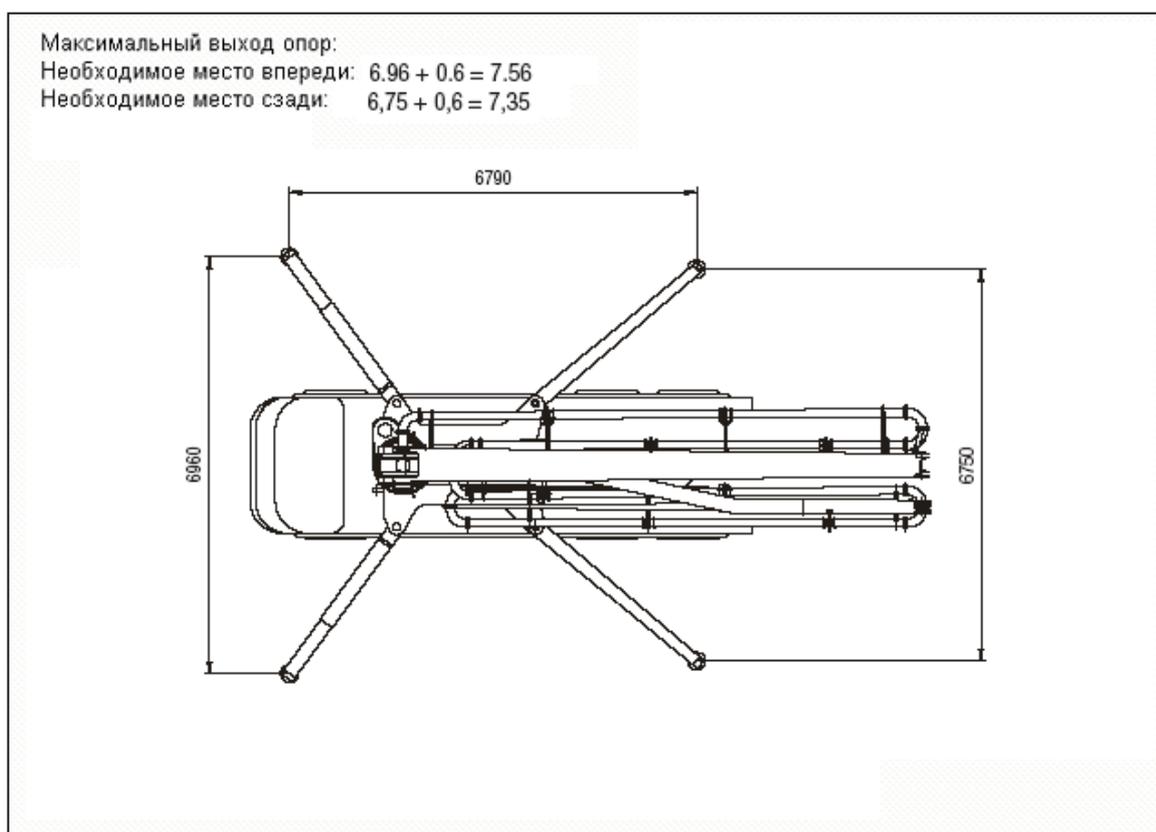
Занимаемая площадь для опор автобетононасоса
